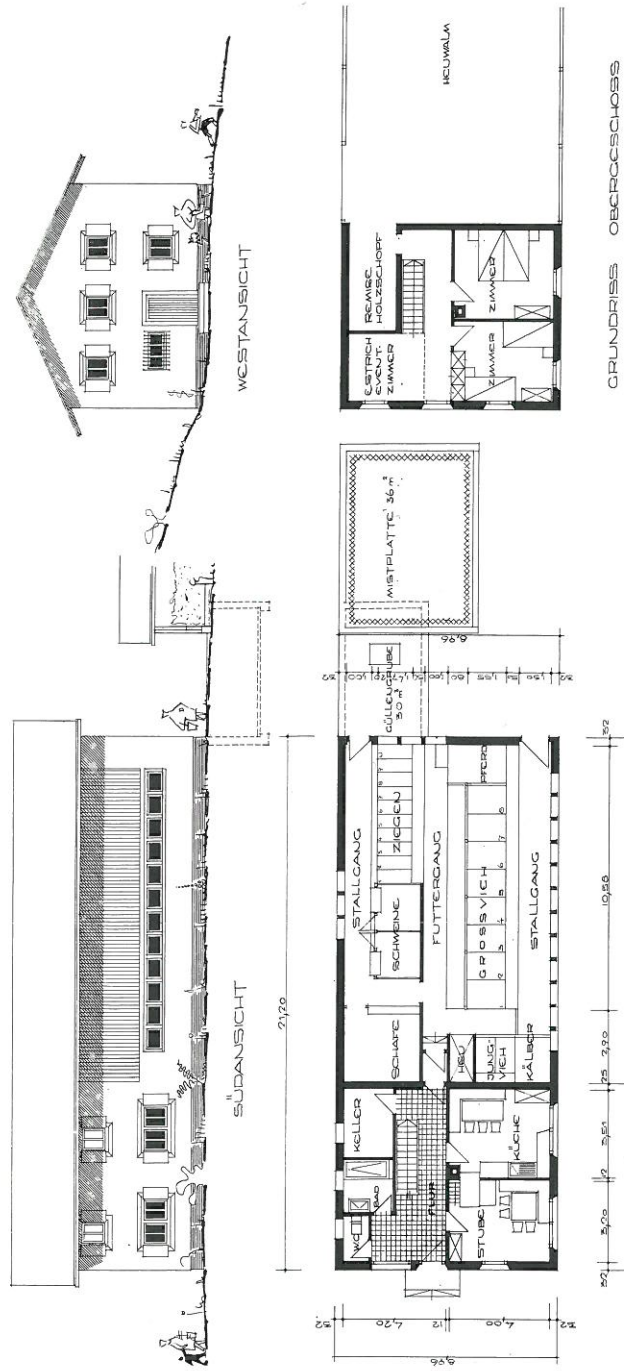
Wintergehöfte Susauna im Engadin, Grundrisse einer Einheit. Masstab 1 : 300
